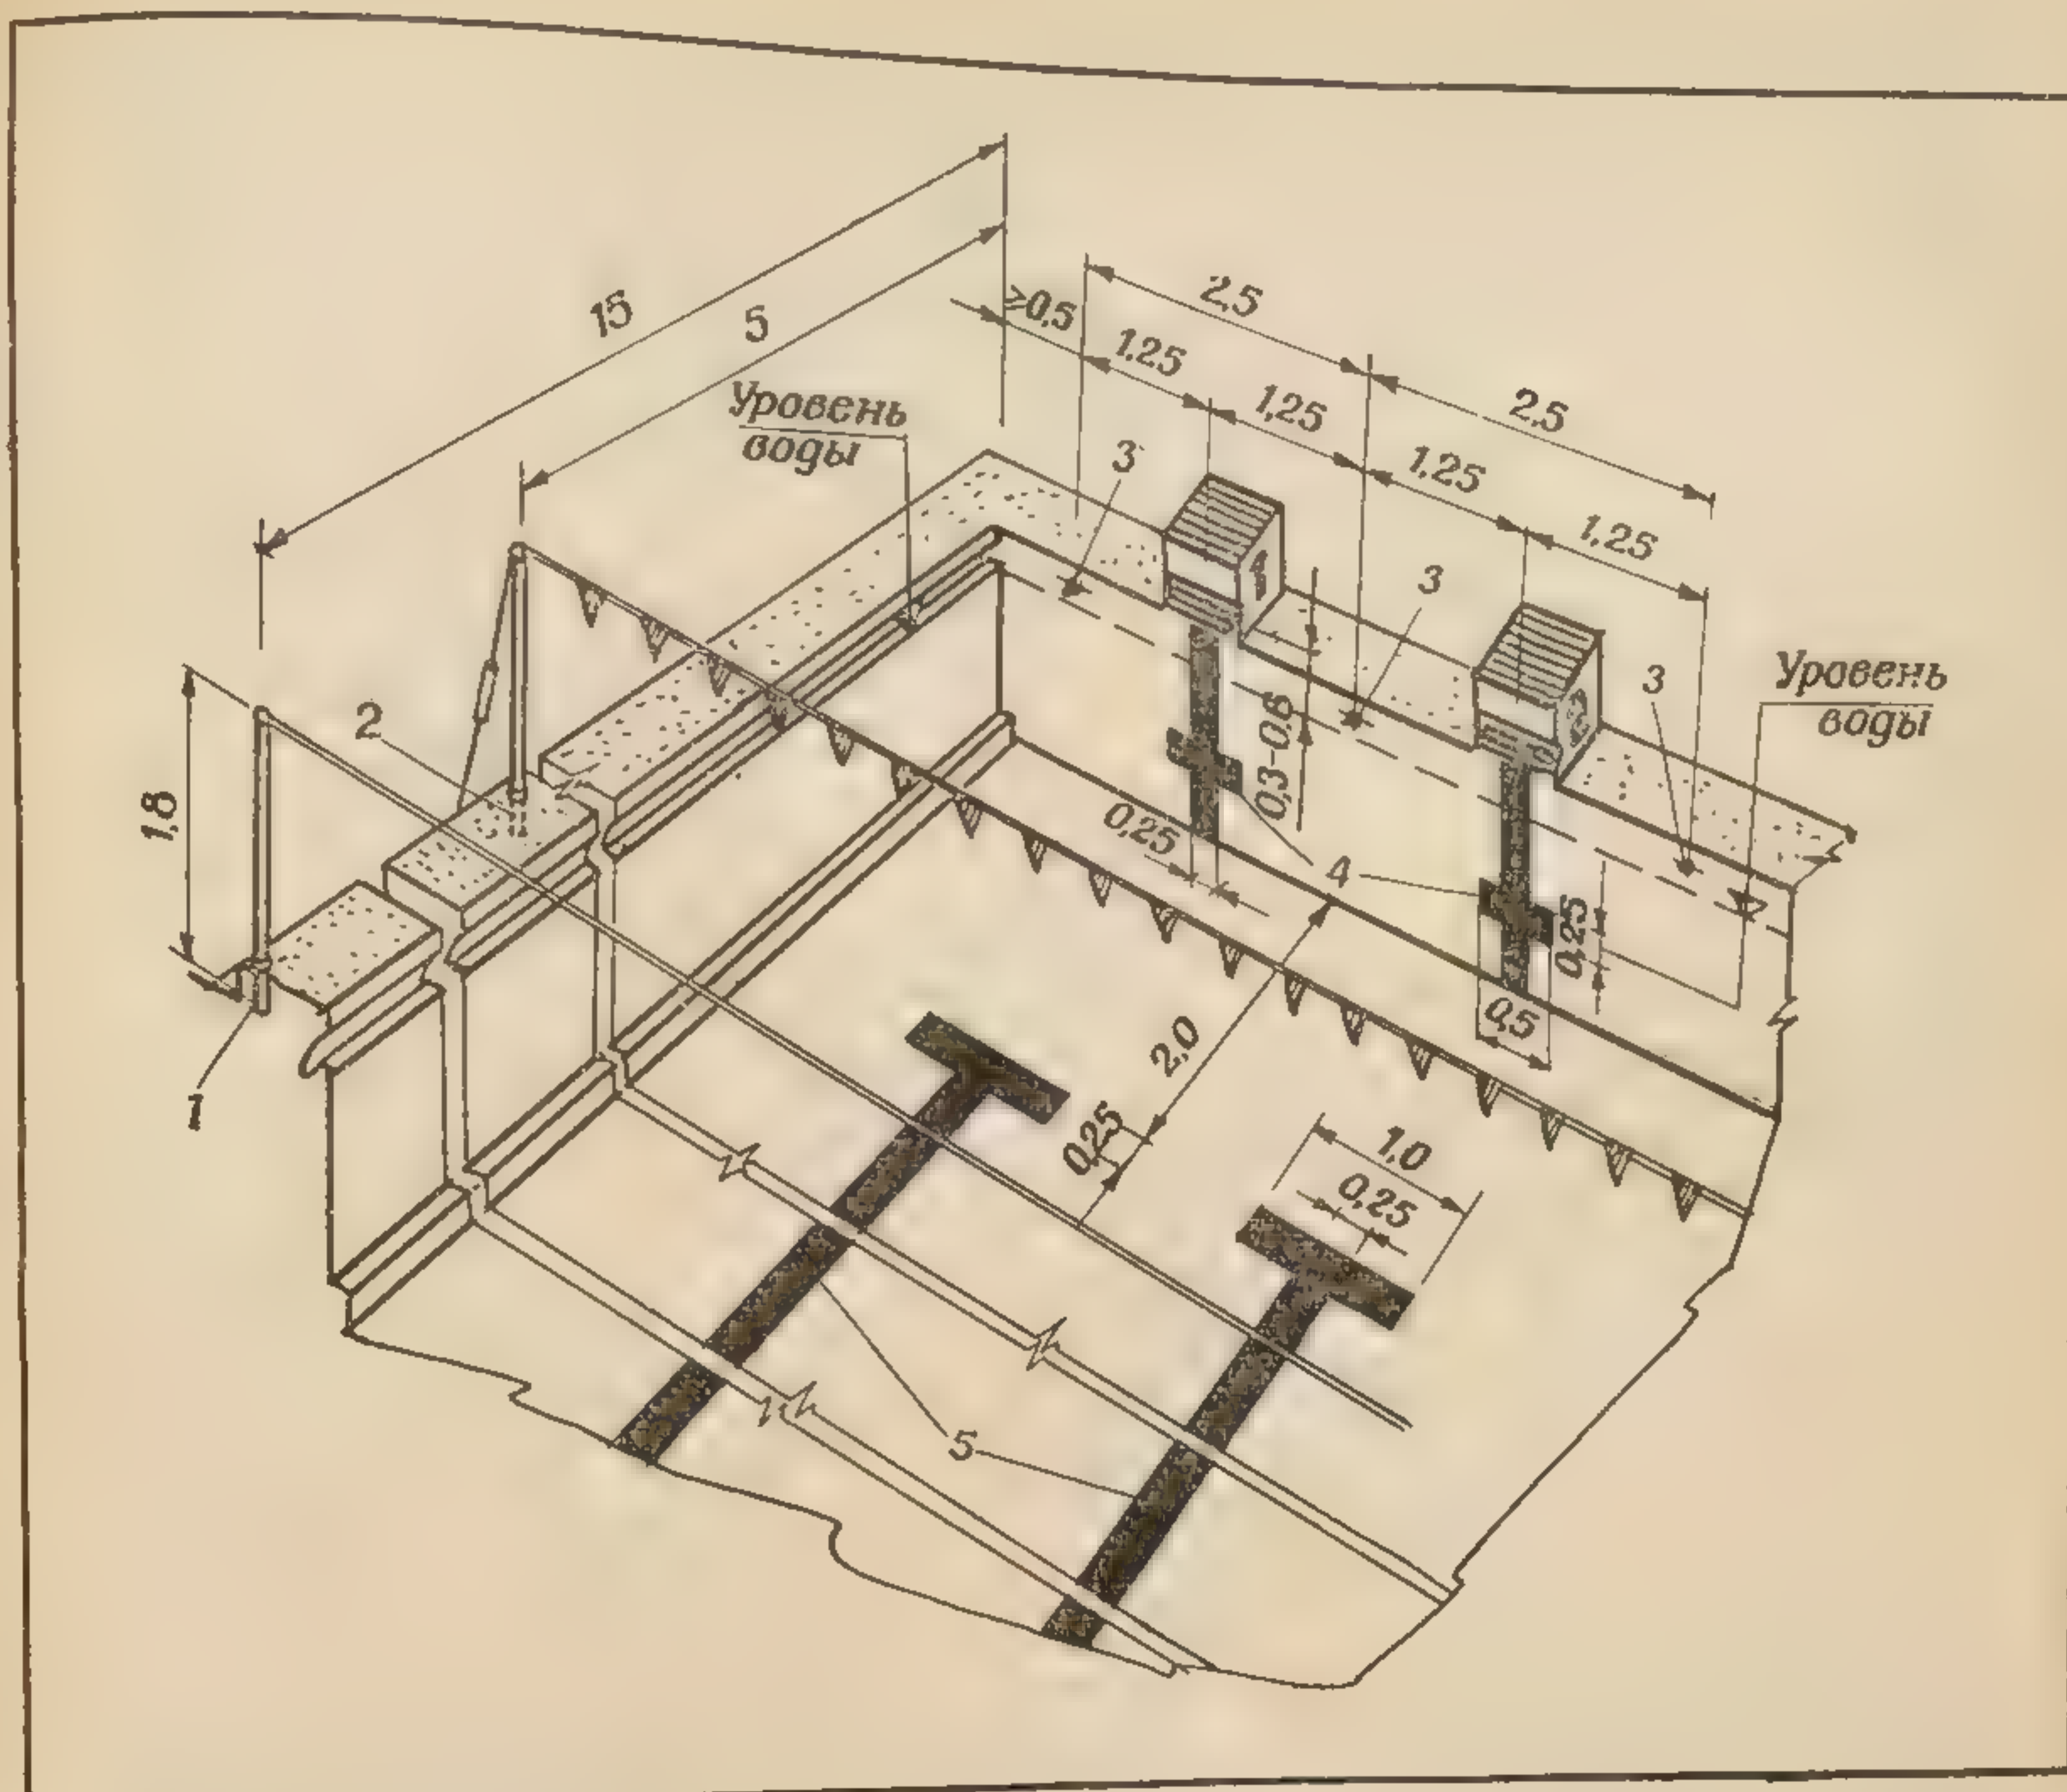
Размещение закладных устройств и разметка ванны для спортивного плавания:
